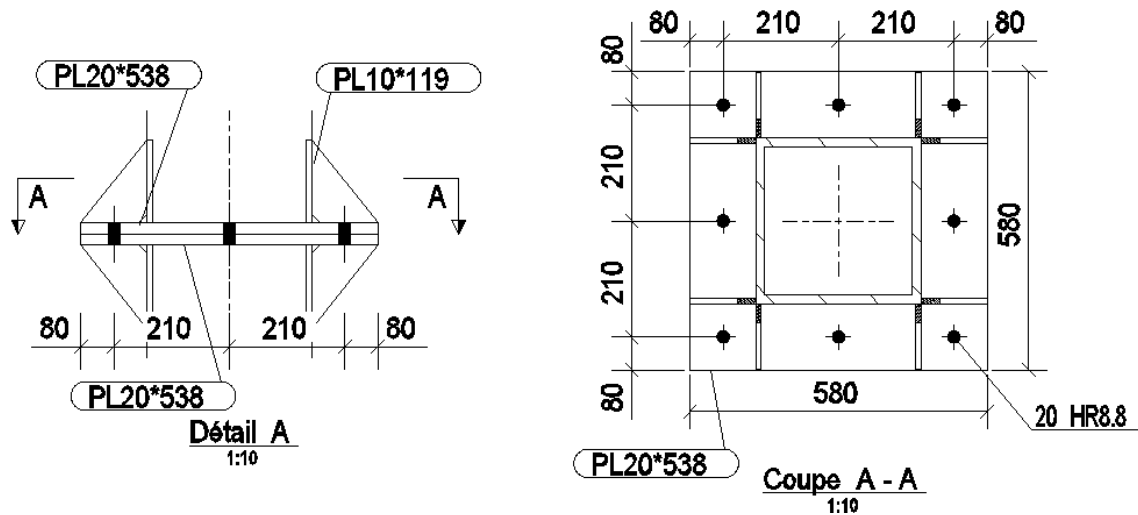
Coupe de l'assemblage (tube 300x300x16)
